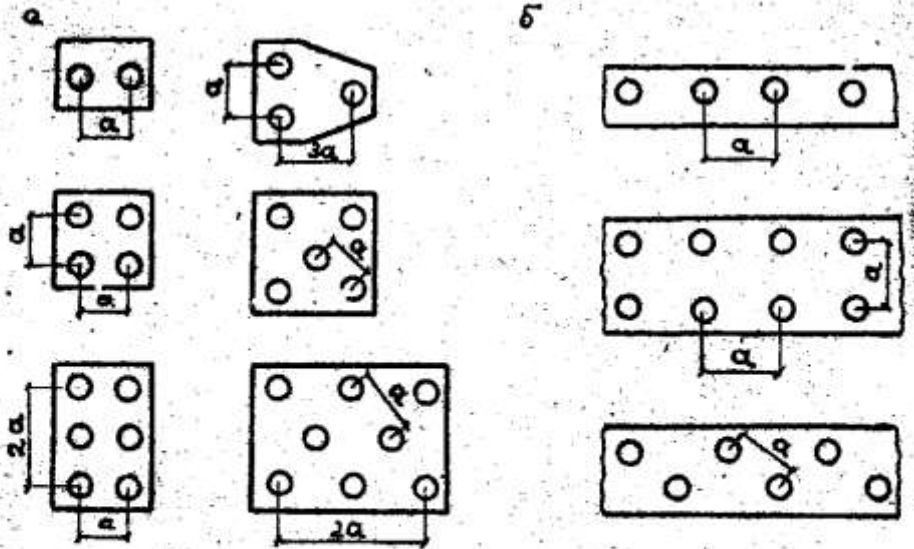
Примеры расположения свай в фундаменте под колонны (а) и под стены (б)
